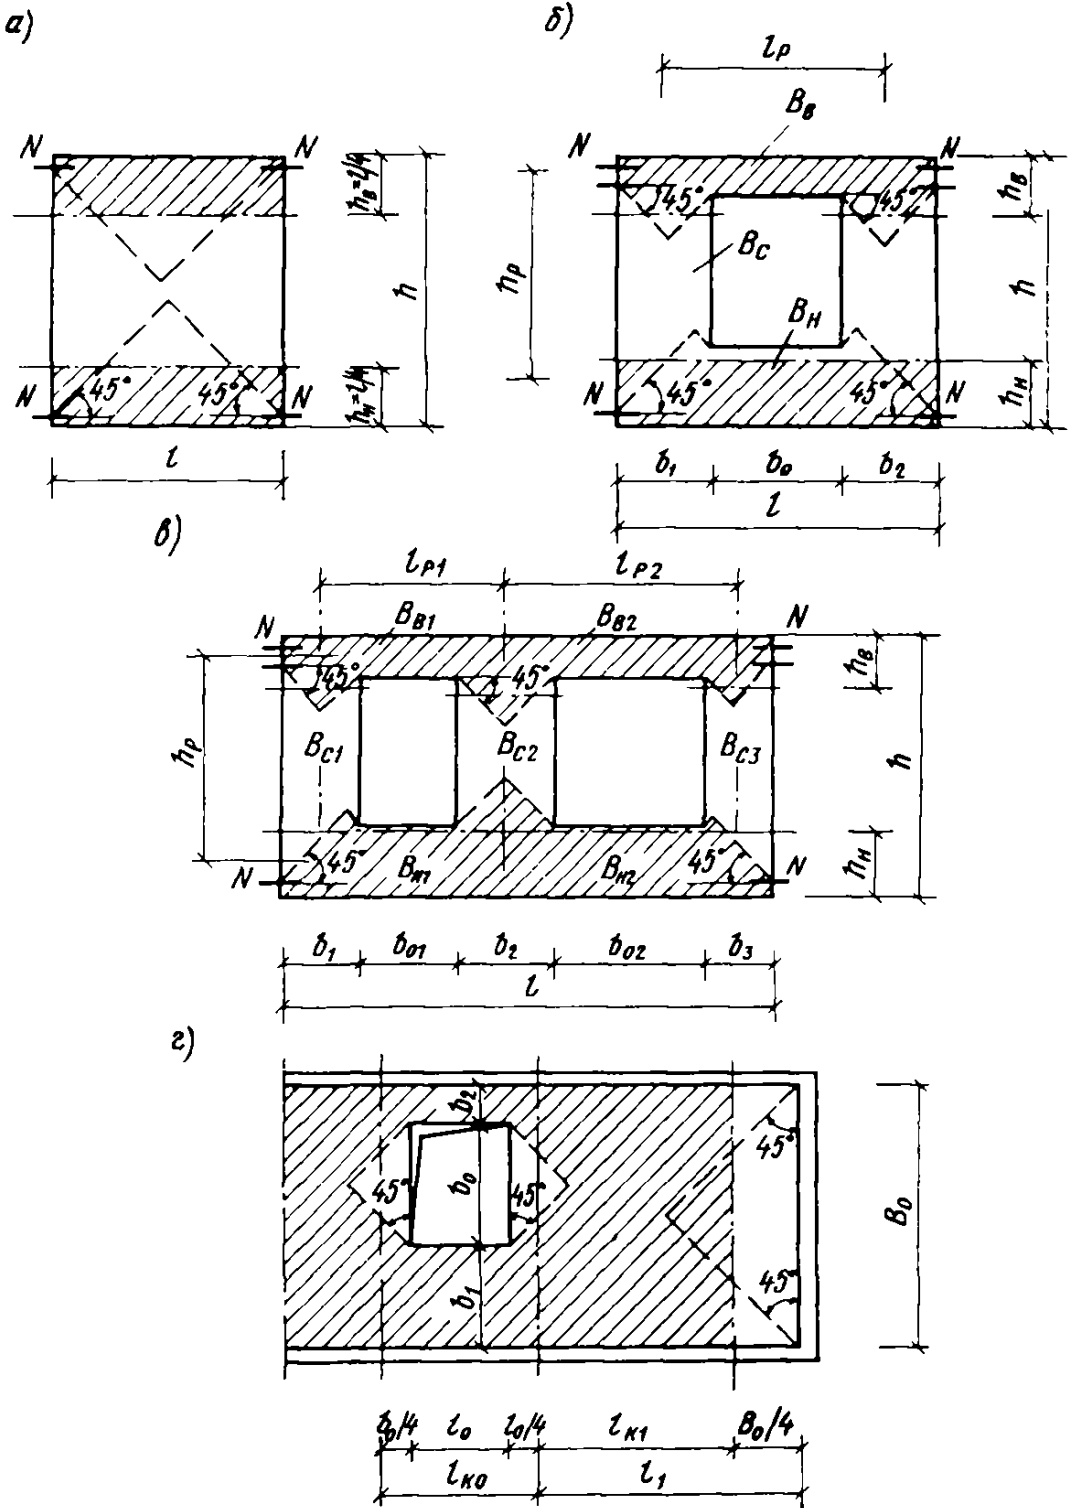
Определение расчетной величины зоны влияния связей и проемов для стеновых панелей и плит перекрытий
